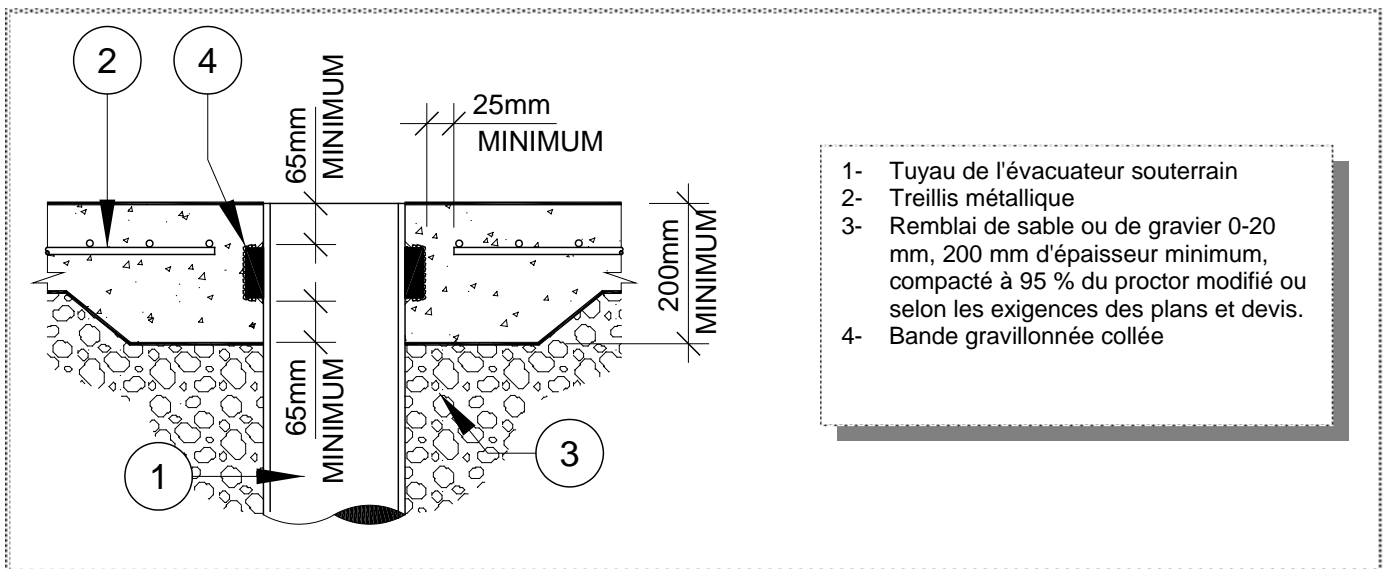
Étanchéité entre une sortie d'évacuateur souterrain et la dalle (Joint de construction)
